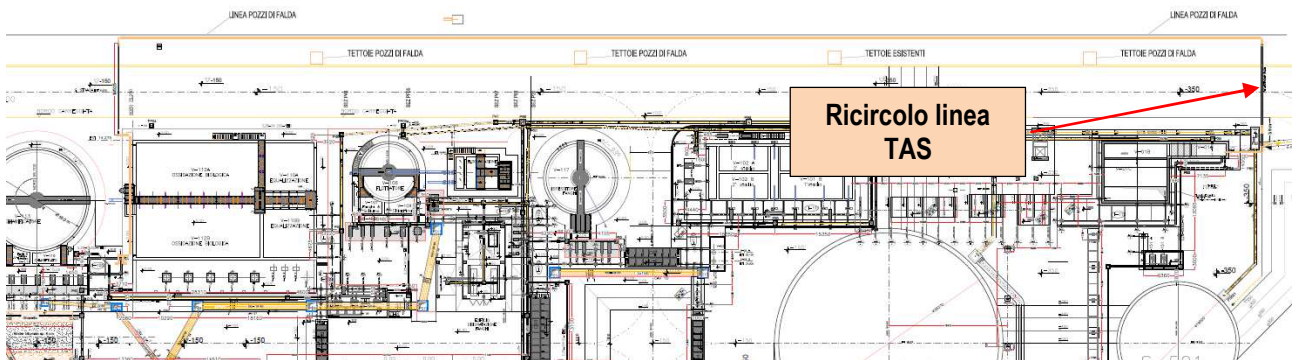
Stralcio planimetrico con individuazione tubazione di ricircolo linea TAS
